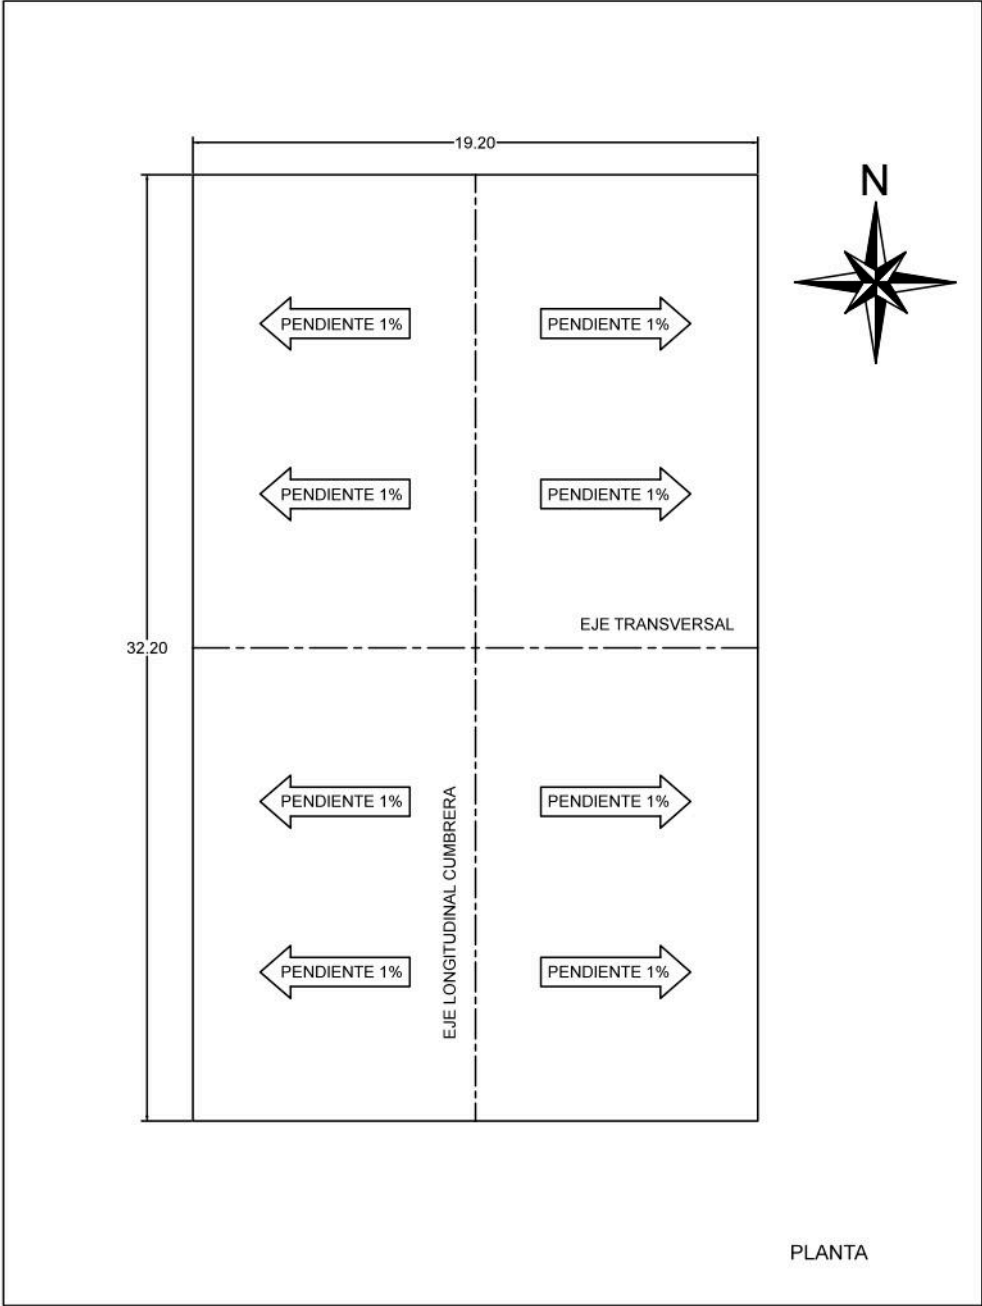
Planta de una cancha deportiva. Fuente: Elaboración propia
